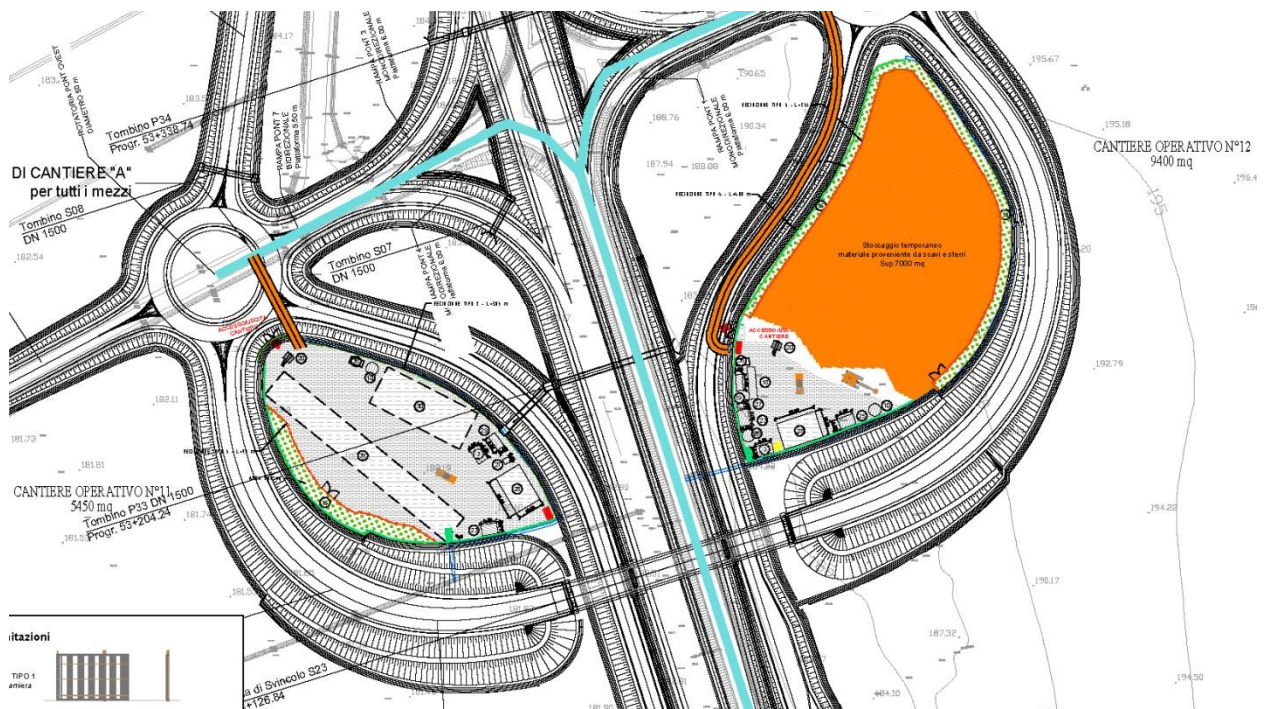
Planimetria cantiere operativo 11 e cantiere operativo 12.
